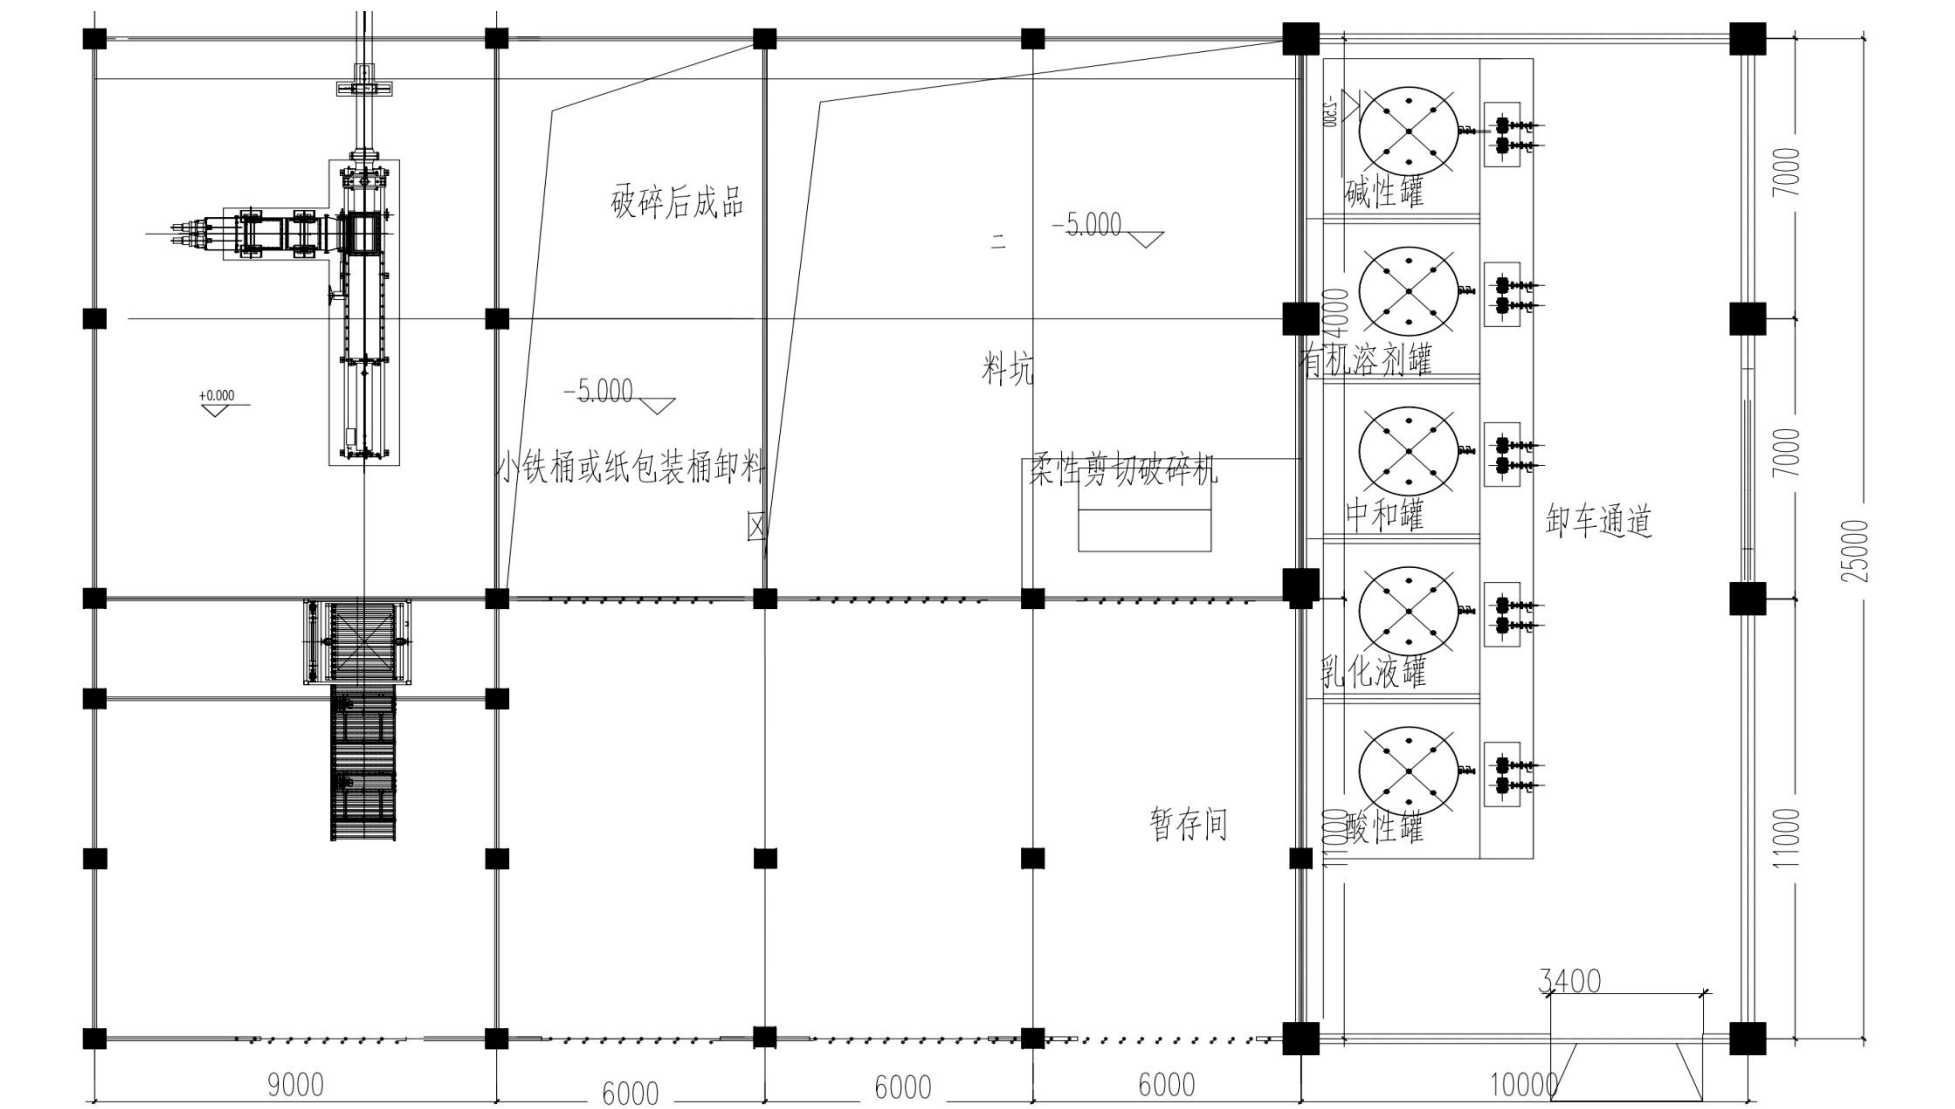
固态、半固态危险废物预处理（SMP）系统平面布置图
